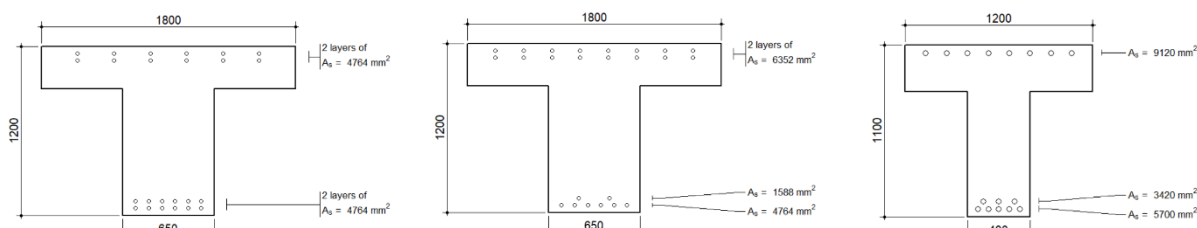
Armadura nas secções de apoio: secção 1 (esq.), secção 3 (centro) e carlingas (dir.) [Anexo L]
